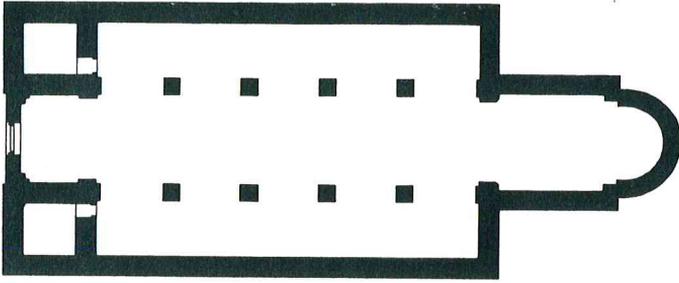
Aiterhofen-St. Margareta, Lkr. Straubing-Bogen. Vereinfacht dargestellter Grundriss der Basilika (nach Böhm/Schmotz 1996 [Anm. 84] 273 Abb. 8, 1) – M. 1:400.
